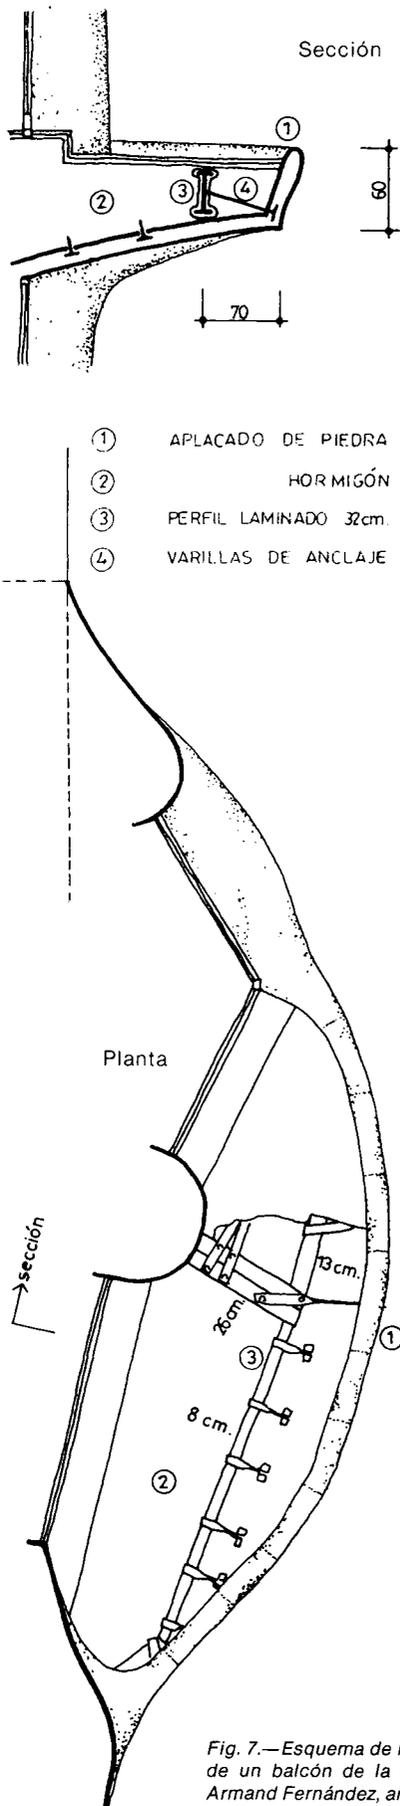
Esquema de la estructura de soporte de un balcón de la casa Milà. Planimetría, Armand Fernández, arquitecto. (Dibujo Txetxu Sanz).
